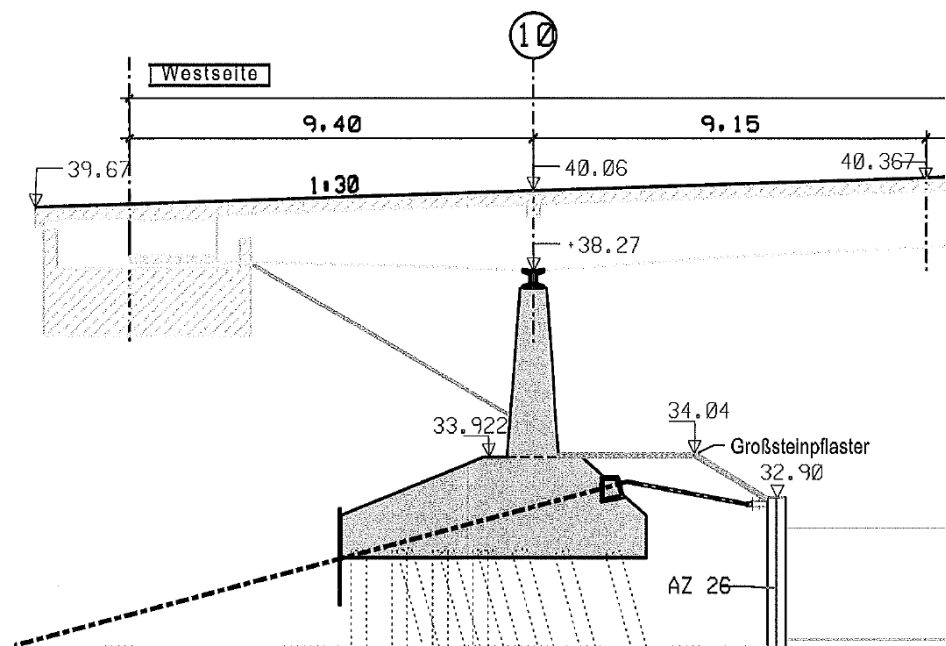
Ausschnitt aus dem Bestandsplan im Bereich des westlichen Pfeilers
